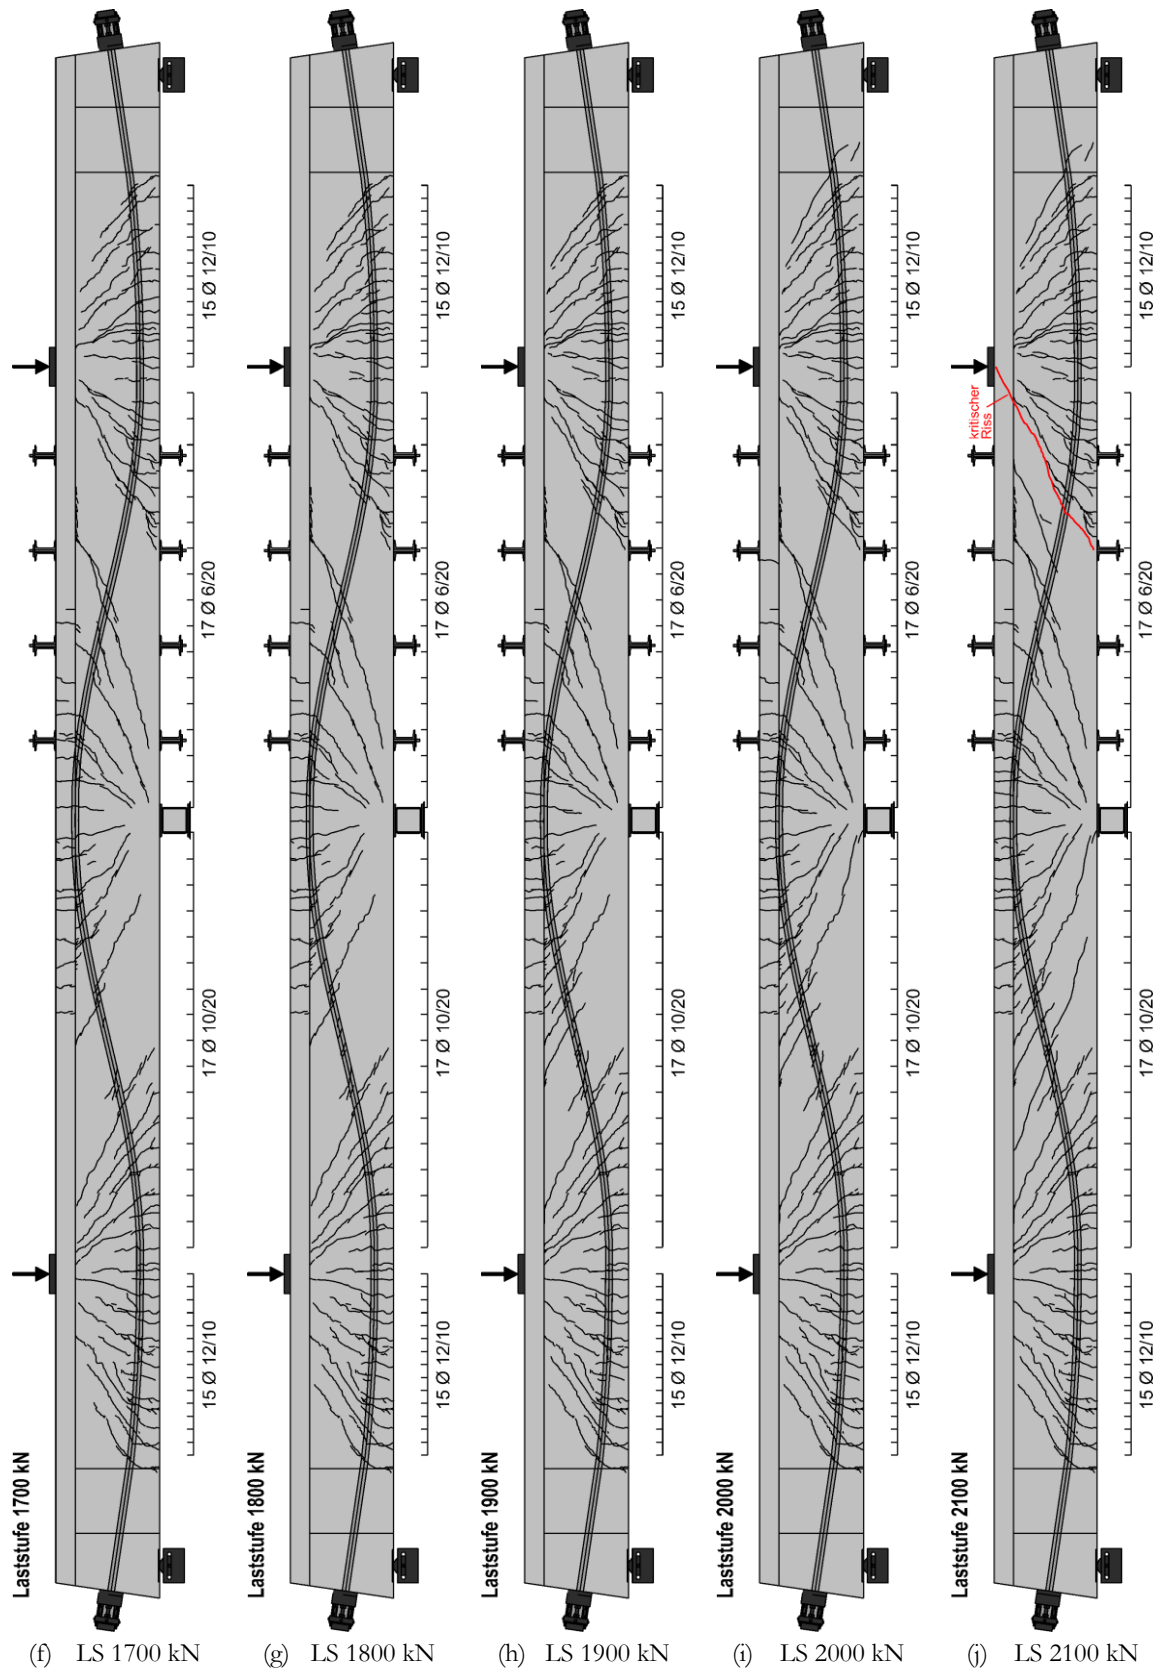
Rissbilder des Versuchsträgers DLT 2 für ausgewählte Laststufen, Teil 2
